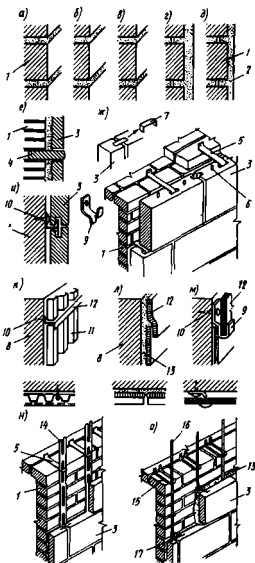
Отделка фасадов каменных стен. Швы кладки:
